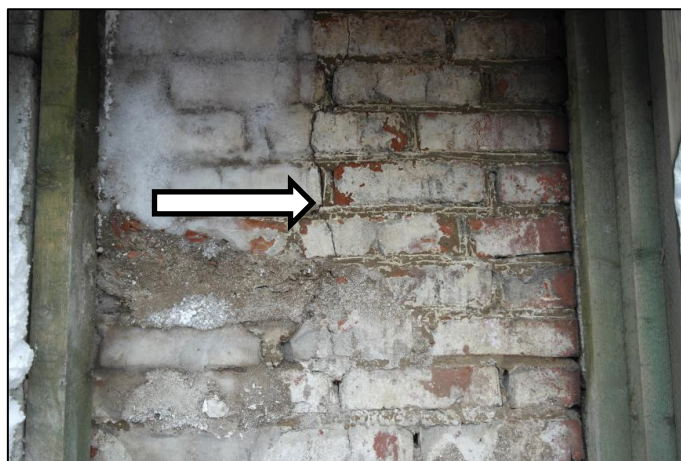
Угол наружной стены холодильника ПХК повреждён сквозными трещинами, образовавшиеся после утепления стен. Поверхность стены покрыта льдом. Снимок выполнен после локального удаления наружного утеплителя
